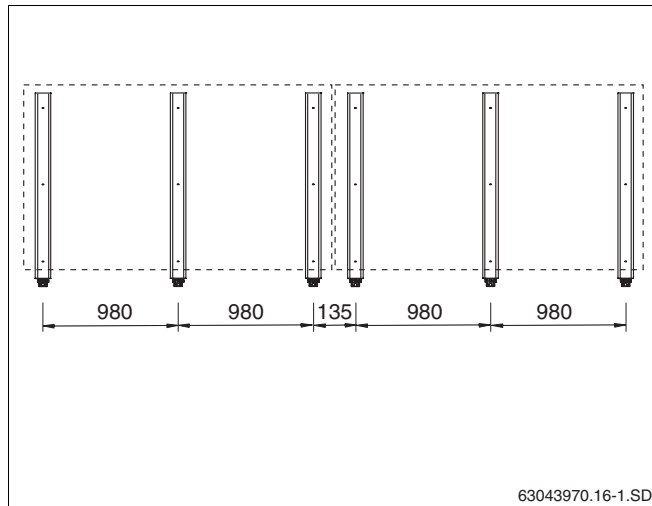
Grundausführung für 2 waagerechte Kollektoren
